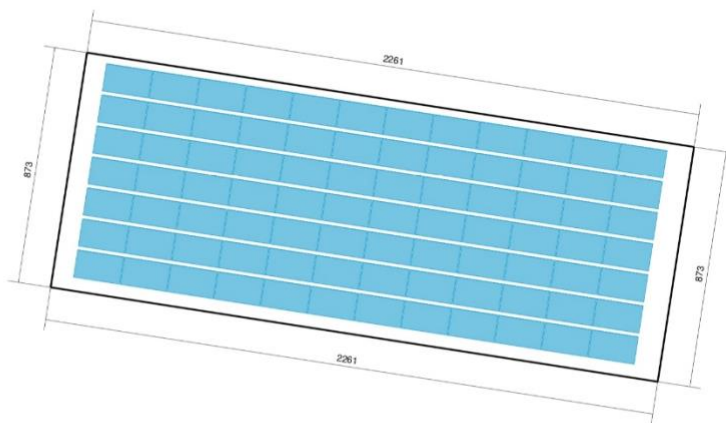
Bürgerfeldstrasse 2.2, Belegungsplan, Dachfläche 1
